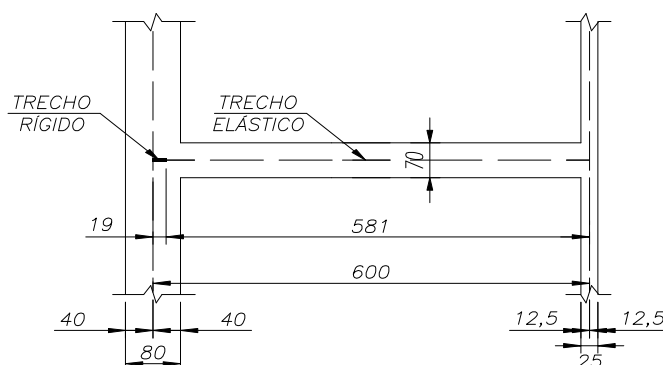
Trecho Rígido e Trecho Elástico em Vigas de 70 Centímetros que se Apoiam em Pilar de 80cm em Uma Extremidade e Pilar de 25cm na Outra Extremidade (Medidas em Centímetro)
